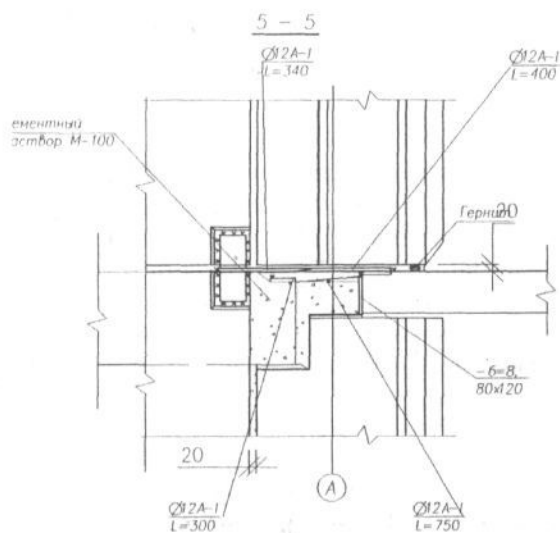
Стык балконной плиты, наружной панели с перегородкой и панелью перекрытия
